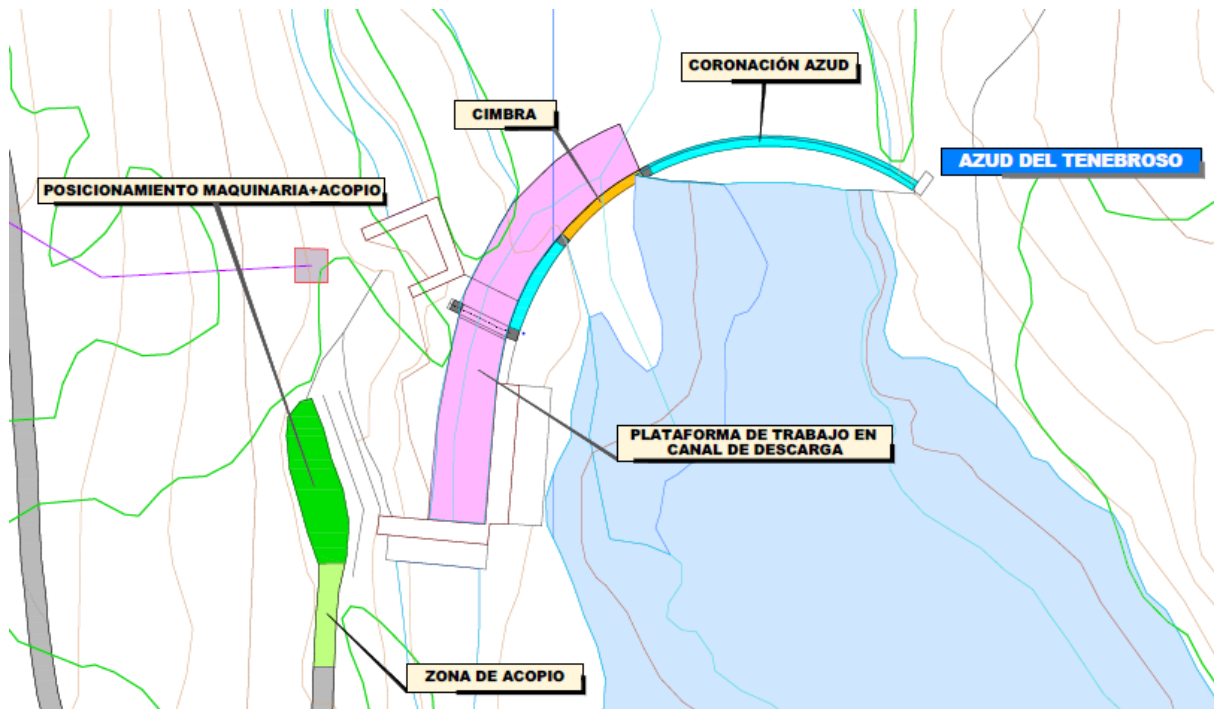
Alternativas 6 o 7: Planta de ocupación.
